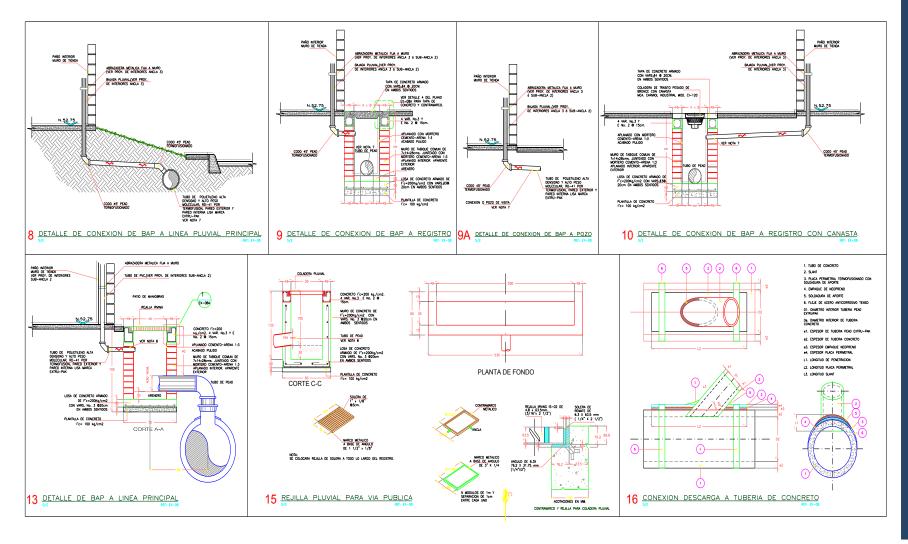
Plano Detalles pluviales, Referencia Plano: CPJ-EX-08B.DWG
